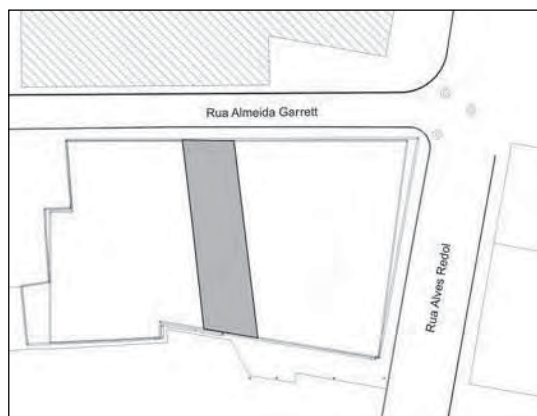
Planta da área intervencionada com a reconstituição do troço de estrada descoberto.
